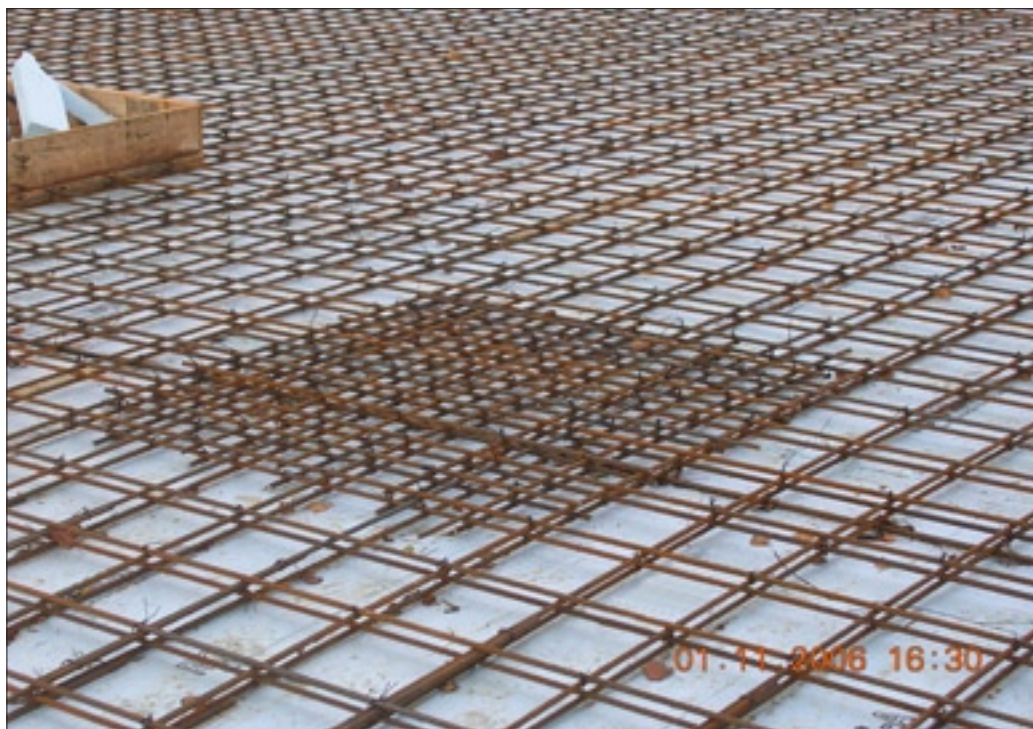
Схема раскладки арматуры по теплоизоляции STYROFOAM GEO
